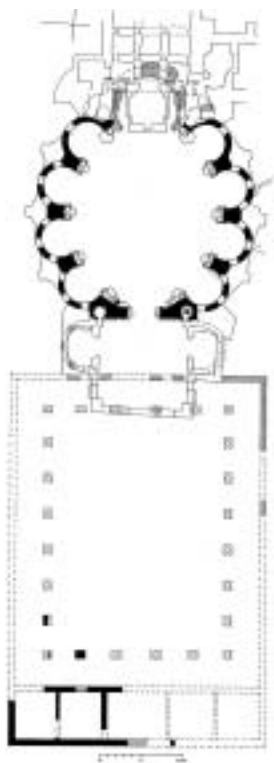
Köln, St. Gereon : Grundriss des spätrömischen Baus
